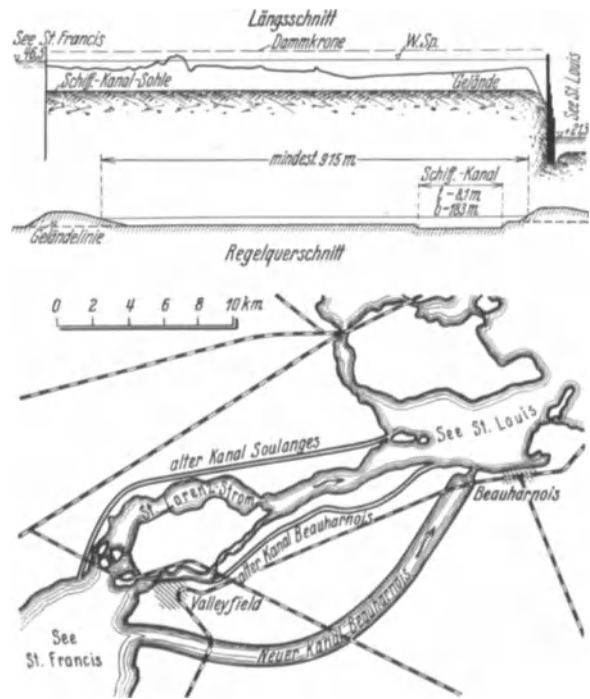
Beauharnois (Längenschnitt und Lageplan). (Verw.)
